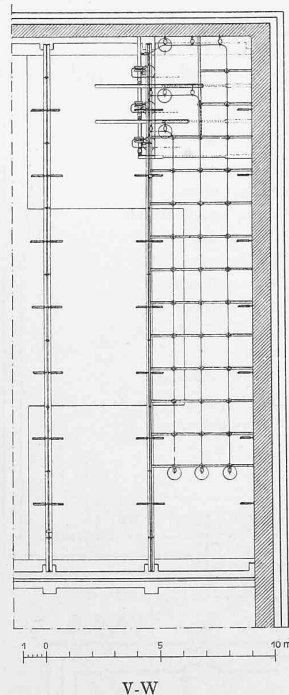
Die Transformatorenstation Castellanza. — Grundrisse und Schnitte. — Masstab 1 : 300.
